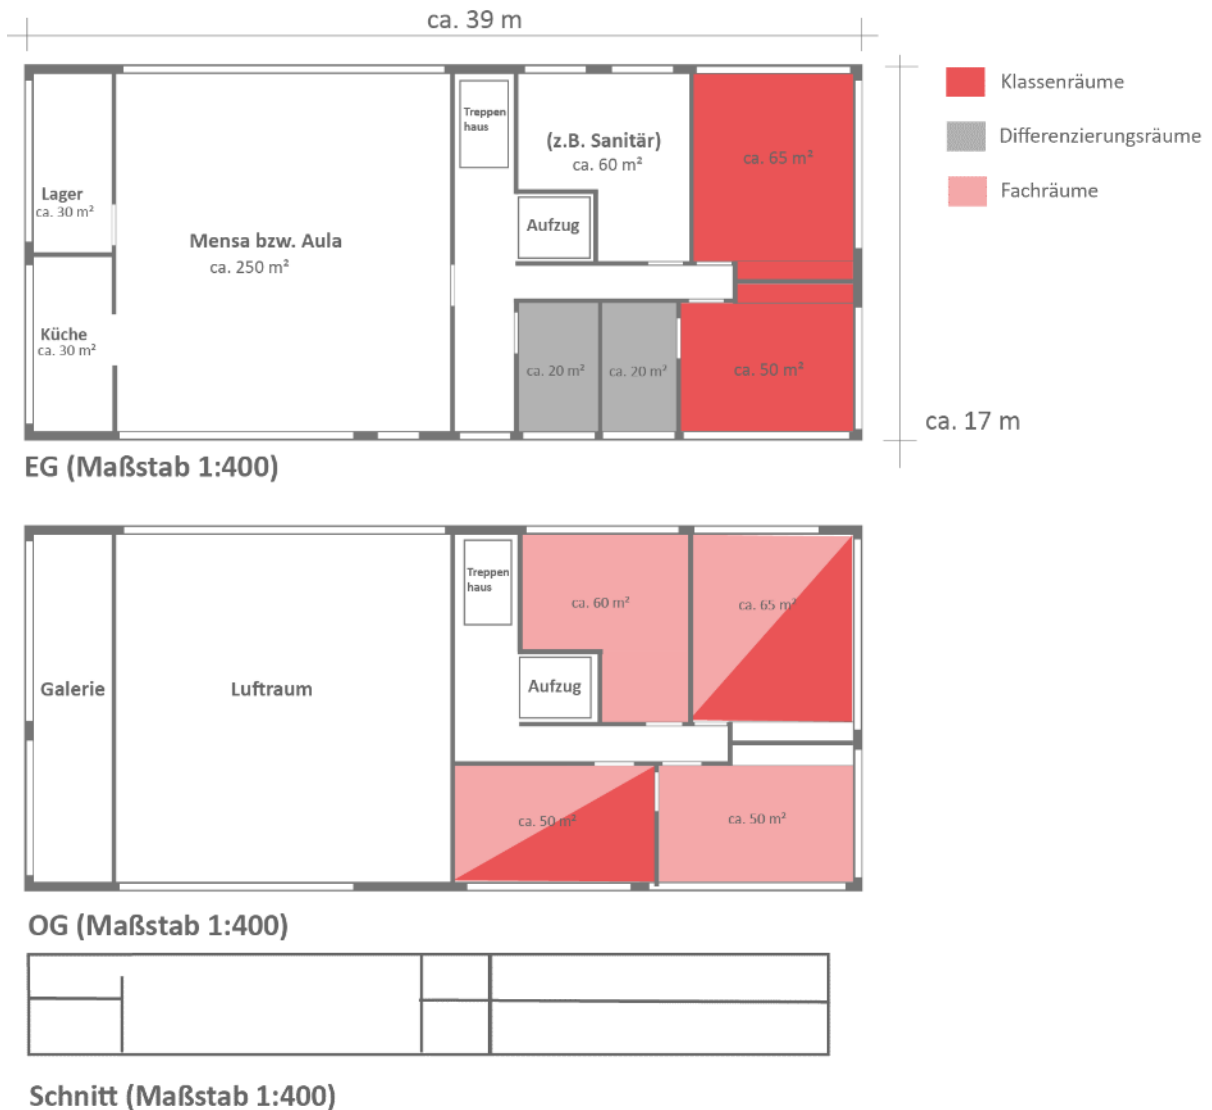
Grundrissvariante 3 für den teilweise zweigeschossigen Neubau einer Mensa/ Aula
